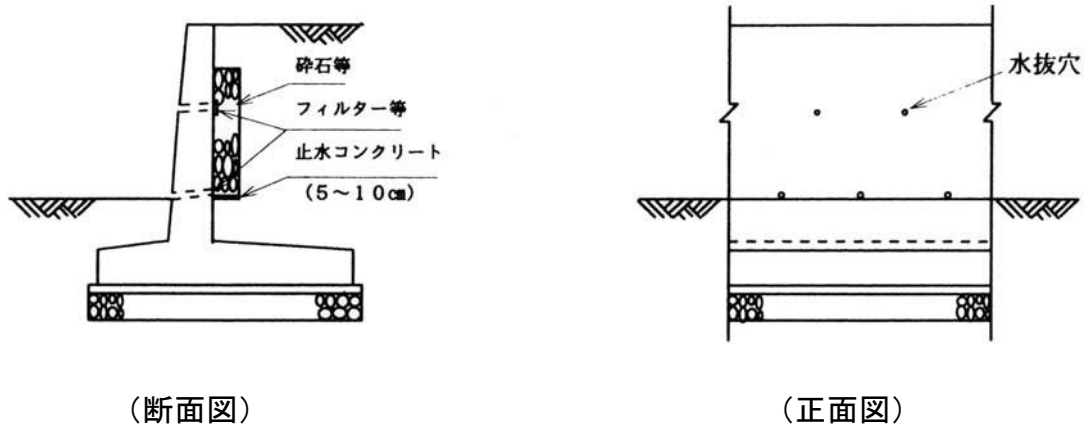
鉄筋コンクリート造擁壁の水抜穴等配置図
